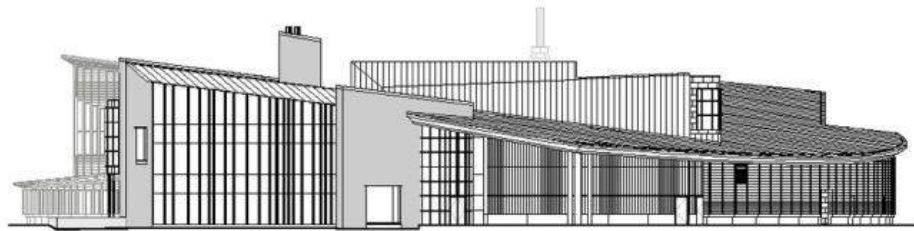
denah Cornell Ornithology Laboratory
